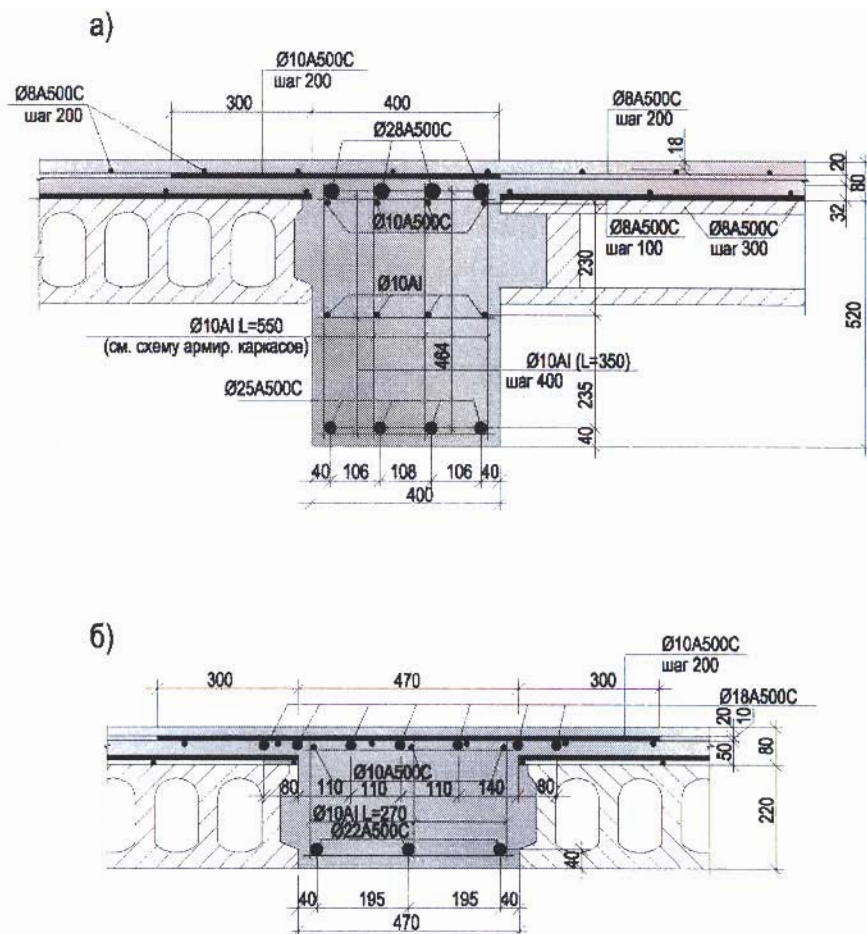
Сечения монолитного железобетонного ригеля (а), и железобетонного ребра (б), размещенного в зазоре между боковыми гранями сборных многопустотных плит
